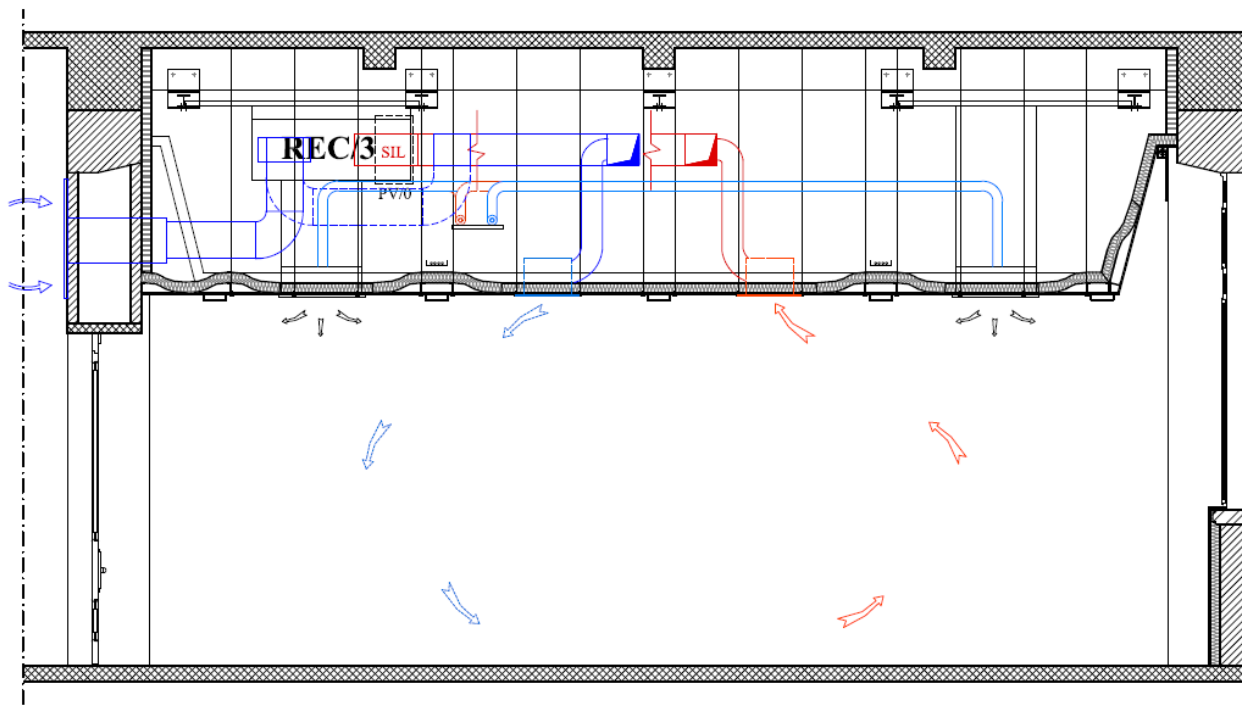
Tipico sezione trasversale delle aule a piano rialzato
